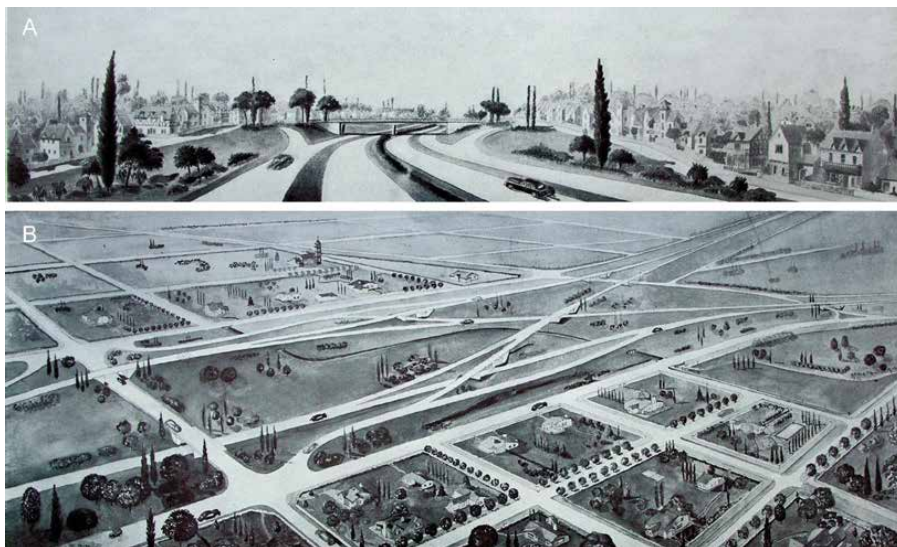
Ilustraciones del diseño proyectado del Acceso Norte. A: Vista del Acceso Norte con el cruce con la calle Melo (Partido de Vicente López, primera sección). B: Vista del Acceso Norte en la bifurcación hacia el ramal Pilar y el ramal Tigre. (Administración General de Vialidad Nacional, 1951.)
